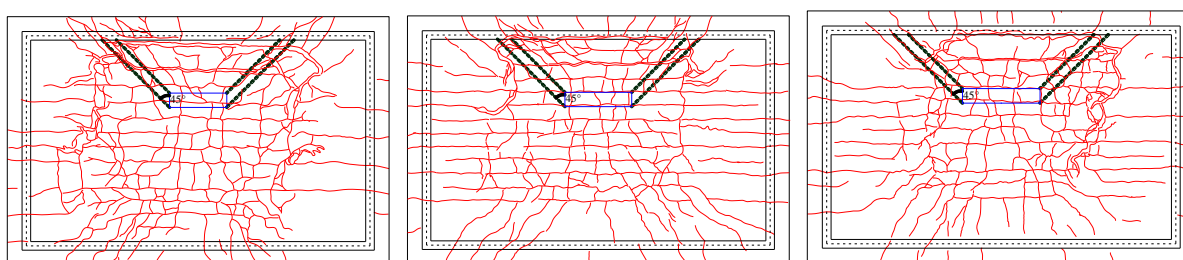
Schémas de fissuration des dalles de la série VI -faces inférieures: (a) Dalle S2, (b) Dalle S9 et (c) Dalle S10
